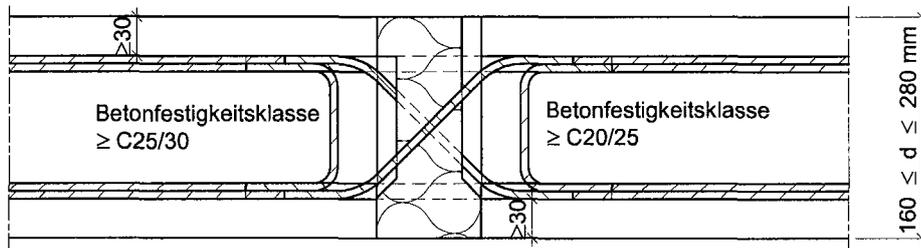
Beispiel Schöck Isokorb Typ D mit Aufhängebewehrung nach Abschn. 3.2.1
